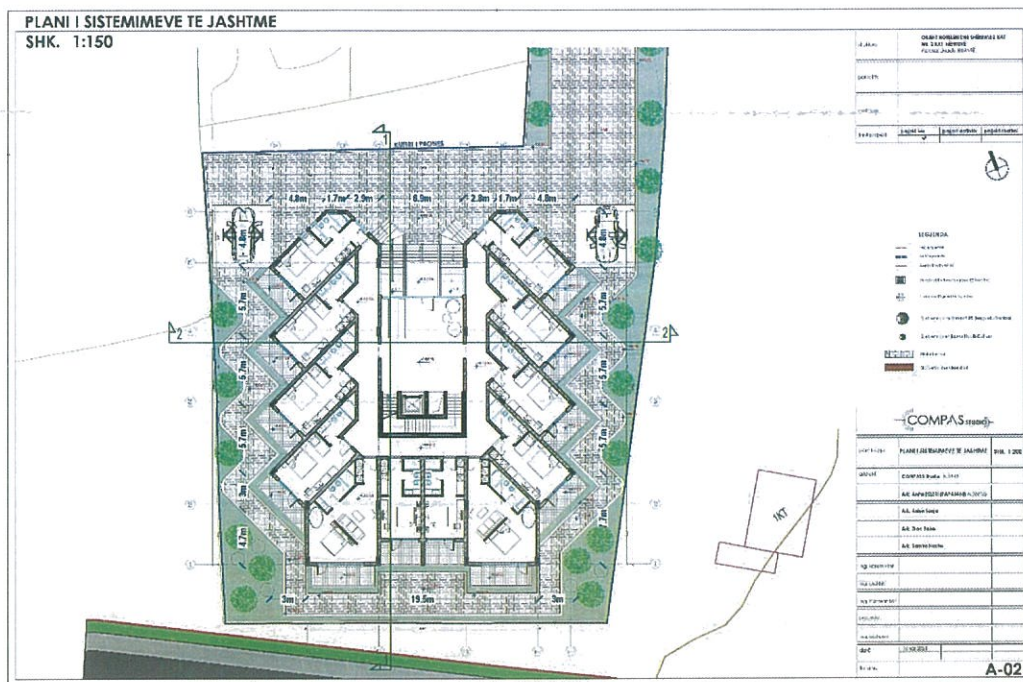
Plani i hapësirave të jashtme të objektit të propozuar
